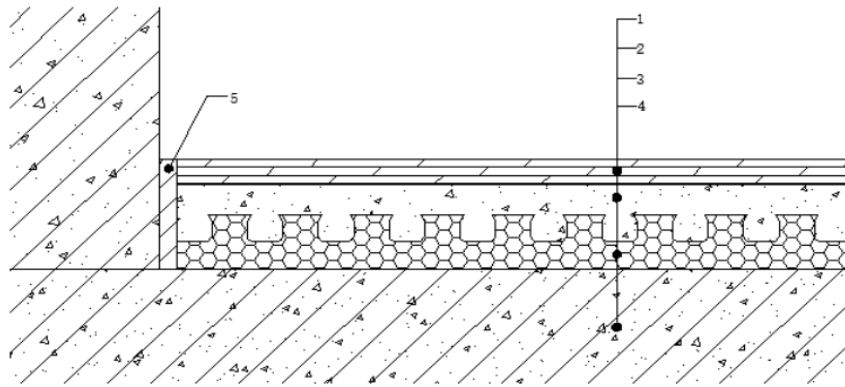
高抗裂混凝土保温隔声系统构造一
